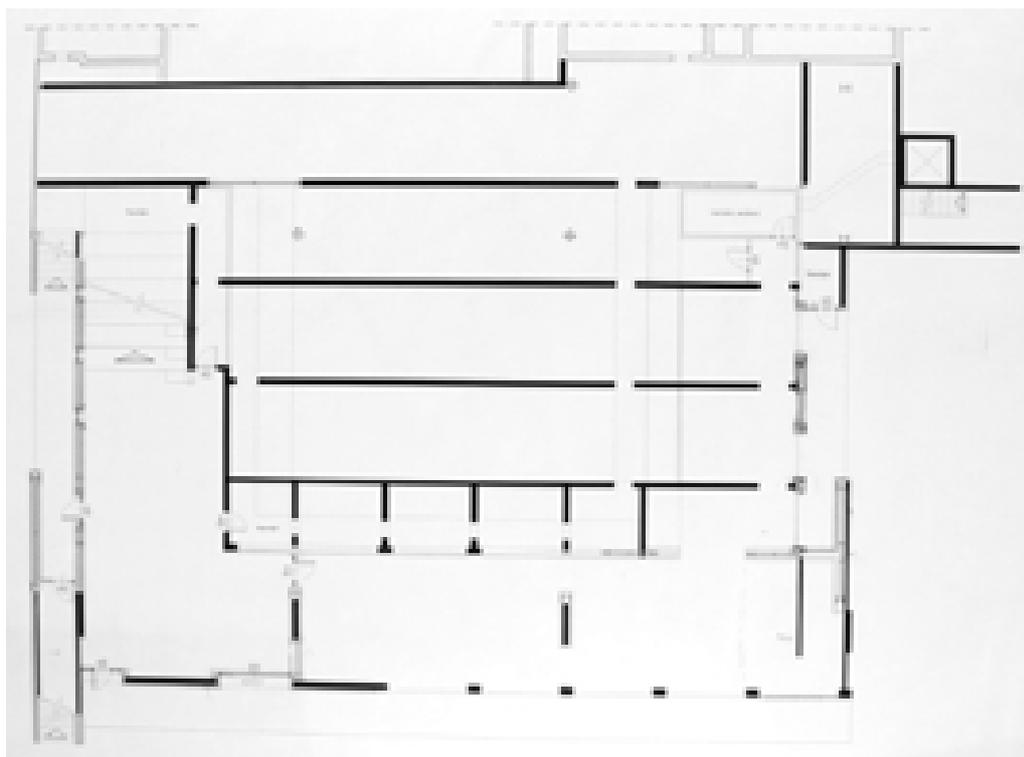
Pianta esecutivo piano terreno –01/07/1996 (AABS-1996.942)
